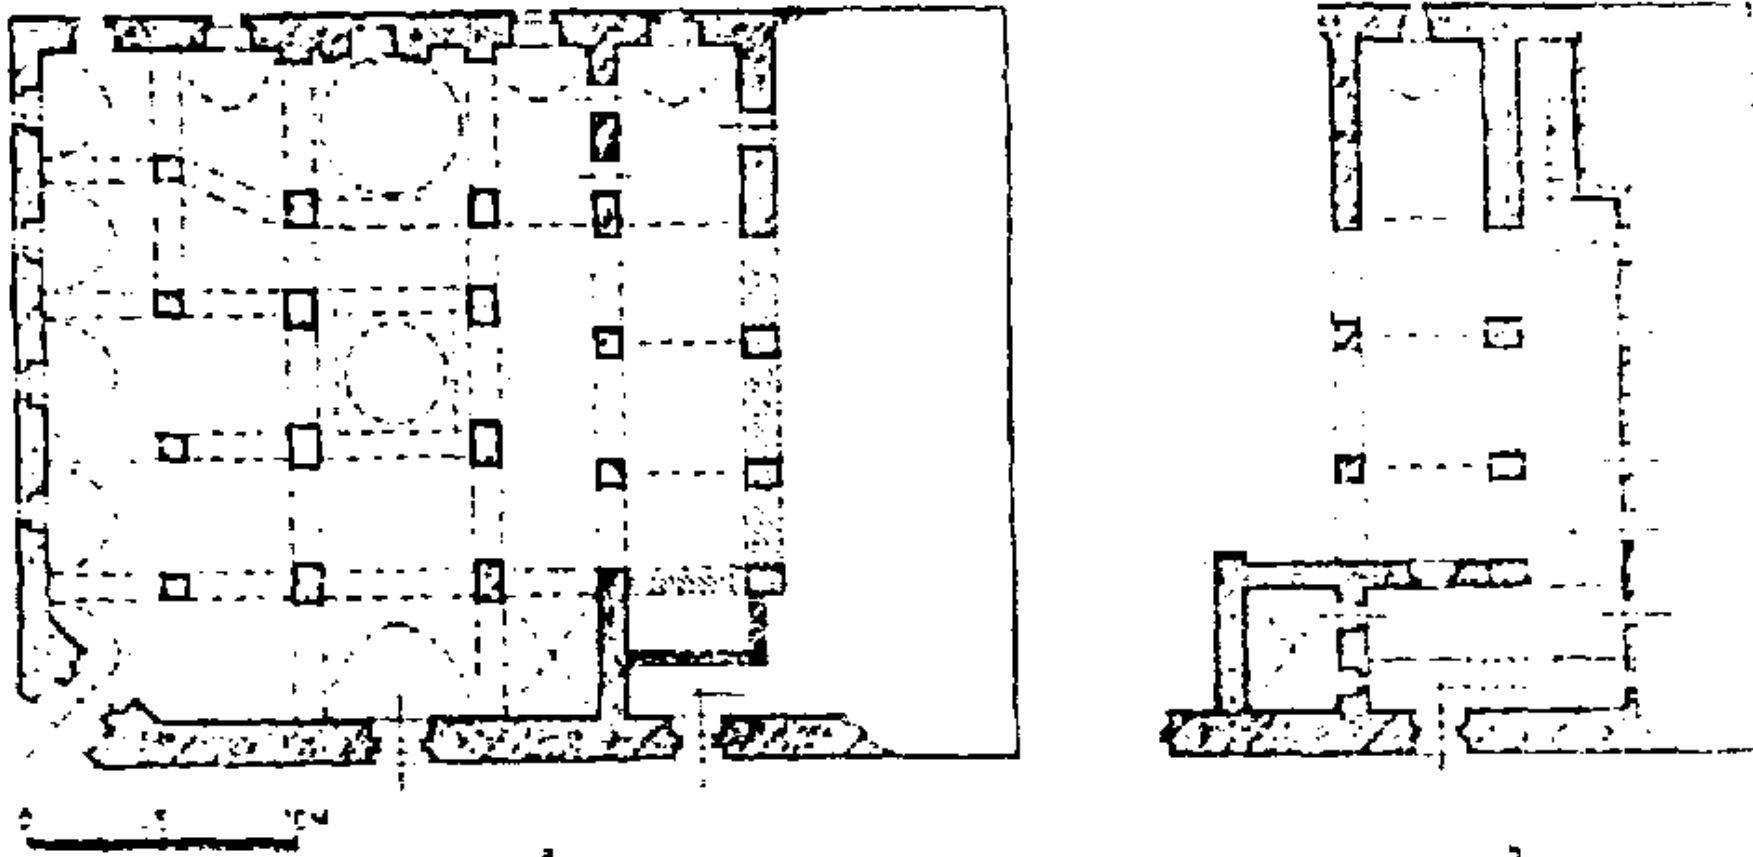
مسقط أفقي لمسجد سیرت عن أصلان آبا.
